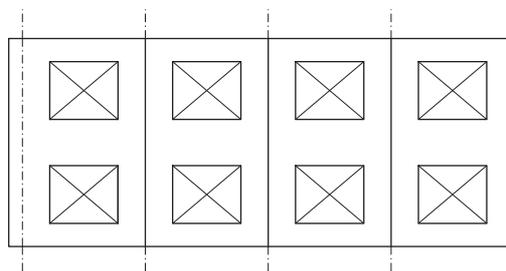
Gevel van een kantoorgebouw opgebouwd uit verdiepingshoge en stramienbrede sandwichelementen. Door de maten van de ramen is er sprake van een horizontale structuur.
